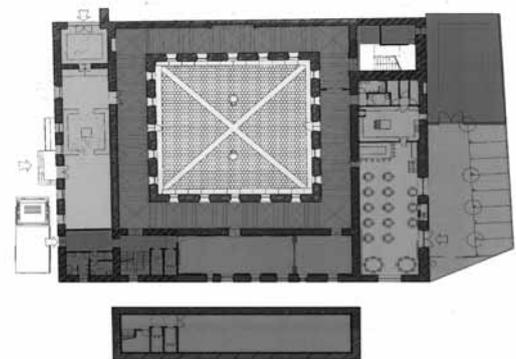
Planos de las distintas plantas del Museo. Planos: Manuel Cuadrado Isasa.
